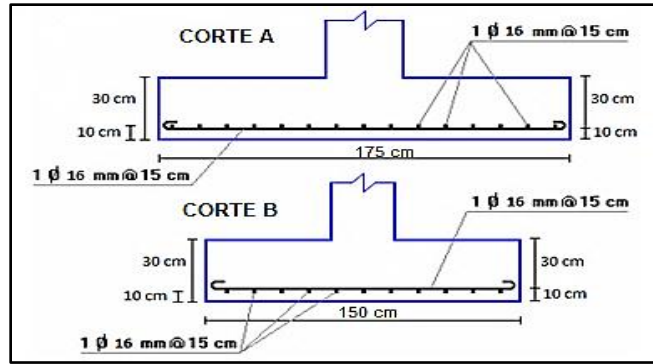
Armado de varillas en la dirección x-y corte A-B.
